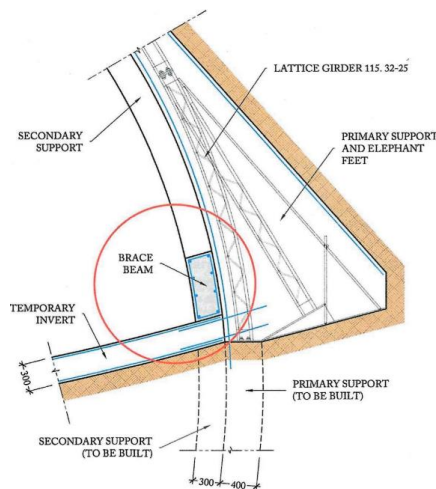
Detalle de la viga de arriostramiento longitudinal.
